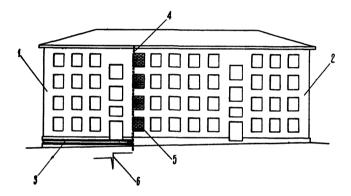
Схема разрезки на отсеки здания, требующего частичного выправления:
